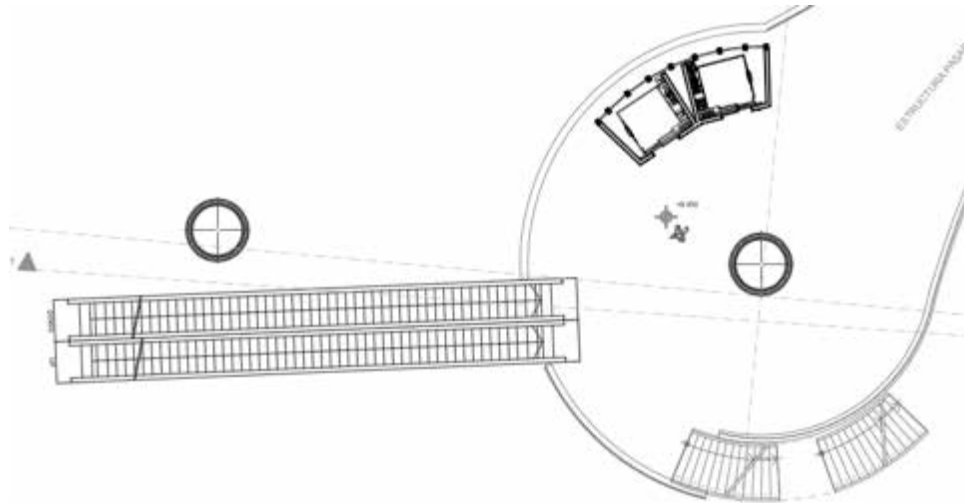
Plaza de acceso 1, planta 2 (+9.45m). (2017)
